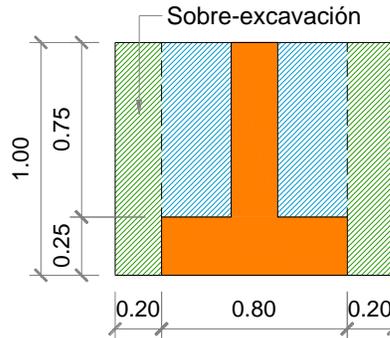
SOBRE-EXCAVACION EN ZAPATAS
